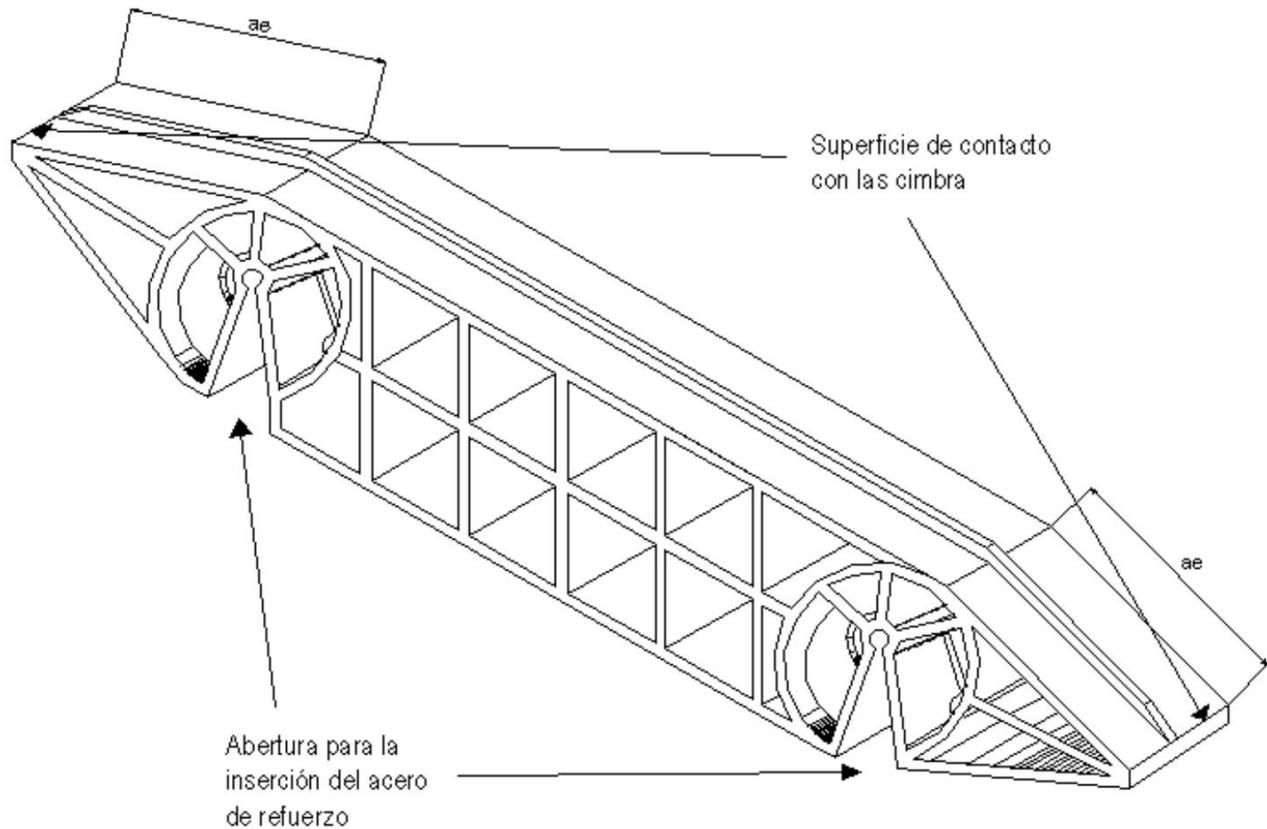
Posicionador plástico para muro de concreto reforzado
